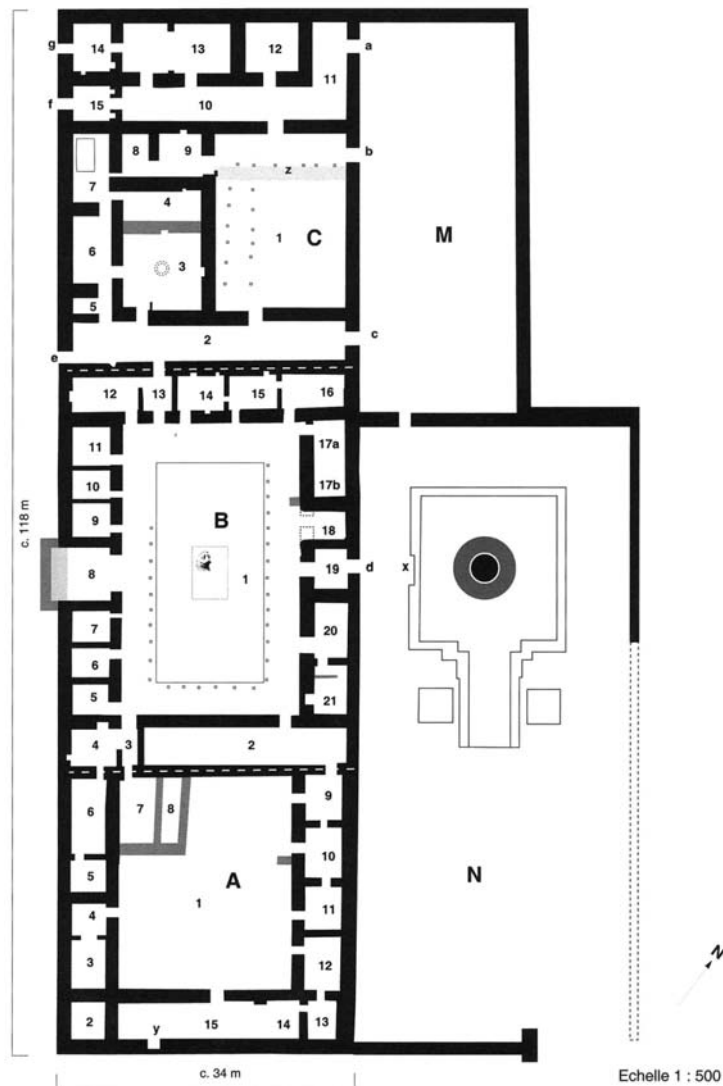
ファヤズ・テパの平面図 (Fussman 2011: Planche 21 を一部改変)
